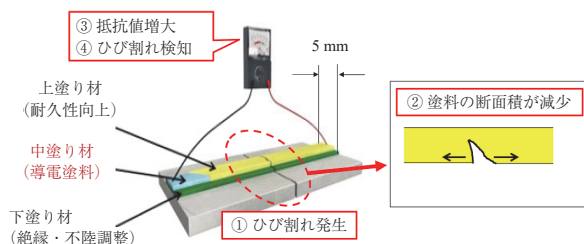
導電性回路の構成とひび割れ検知の原理
